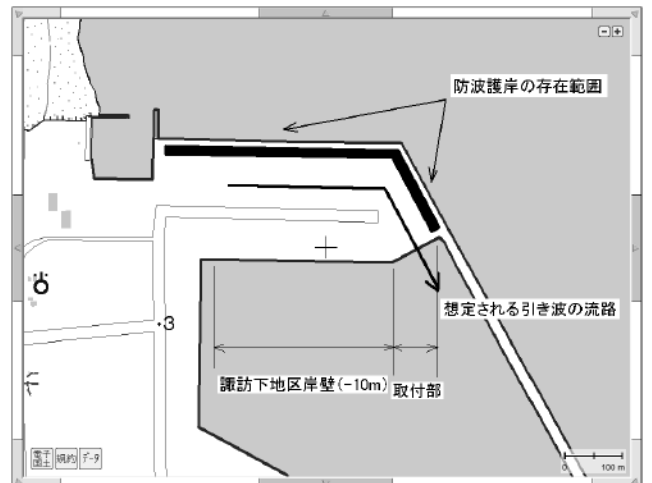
諏訪下地区岸壁 (-10m) 平面図
